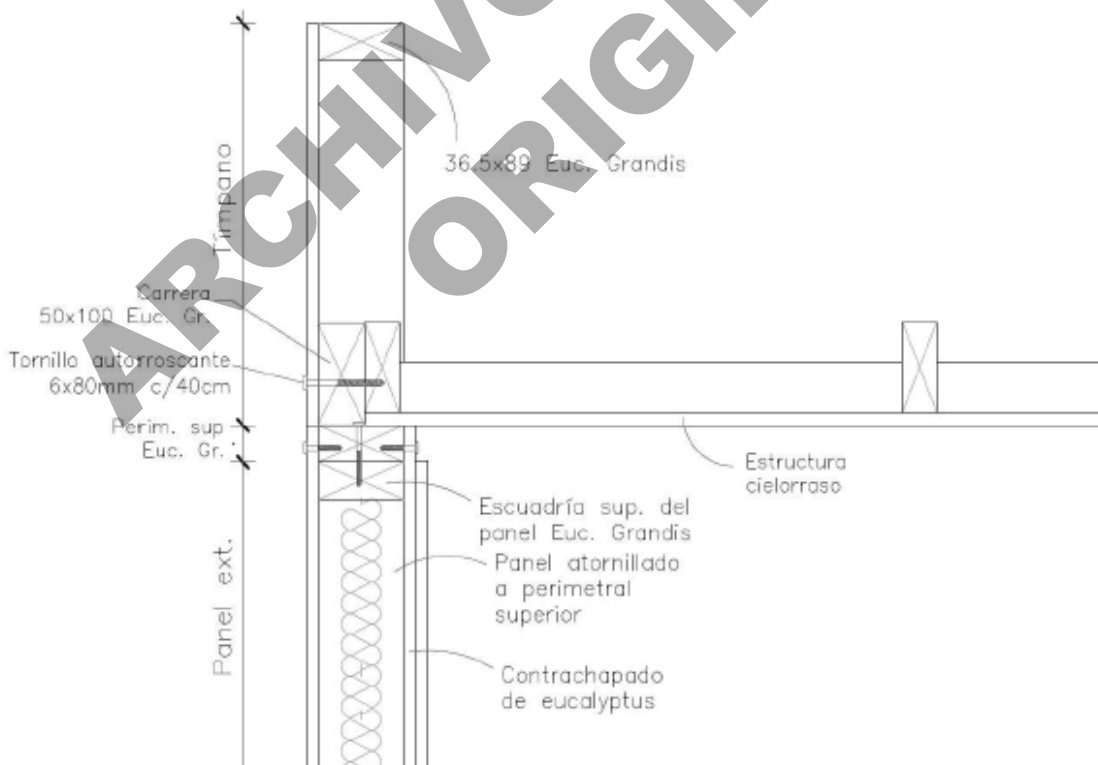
Extremo sup. de muros exteriores, corte longitudinal
